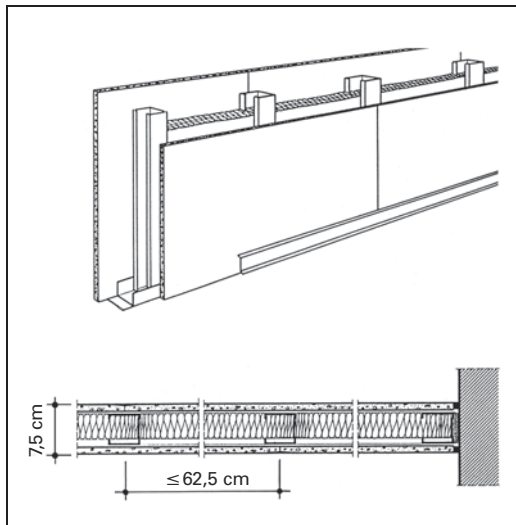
Metallständerwand Einfachständerwerk, einfach beplankt
